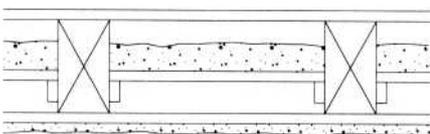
Aufbau einer typischen Holzbalkendecke im Altbau:
